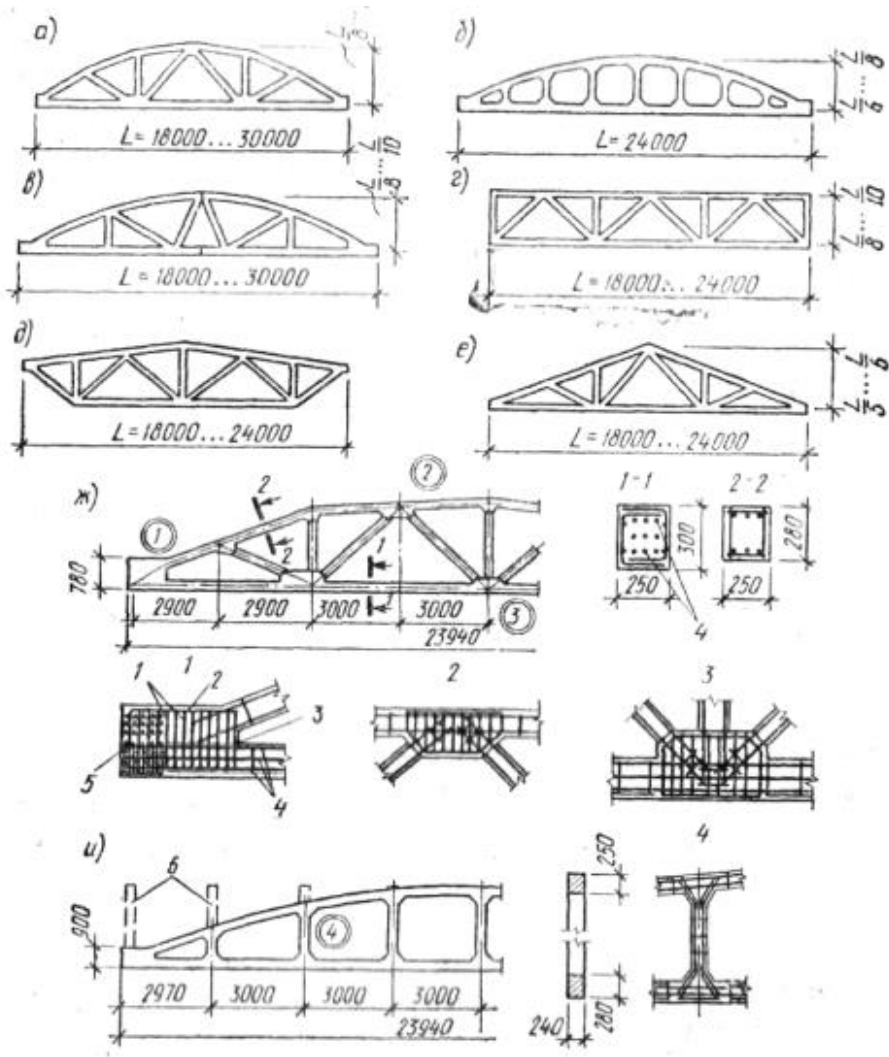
Конструкция железобетонных стропильных ферм:
